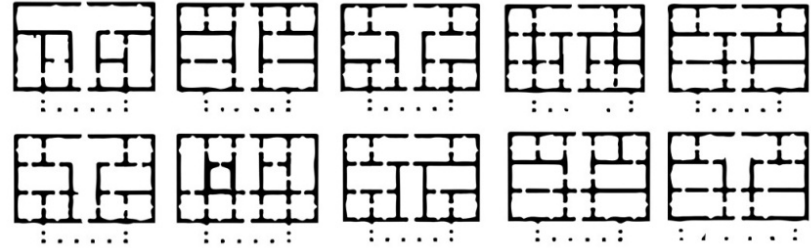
'de GRAPE-SGI ile oluşturulan Palladyan plan şeması veri setinden 10 plan şeması gösterilmiştir.
